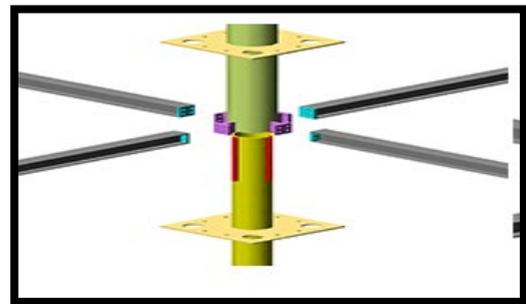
poteaux mixte béton blindé et acier (source :mémoire Achour,2013)
